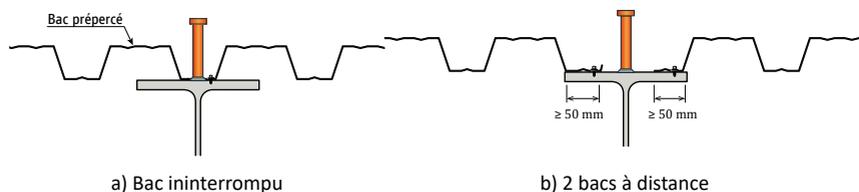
Traitement de tôles nervurées parallèles à l'axe de la poutre
